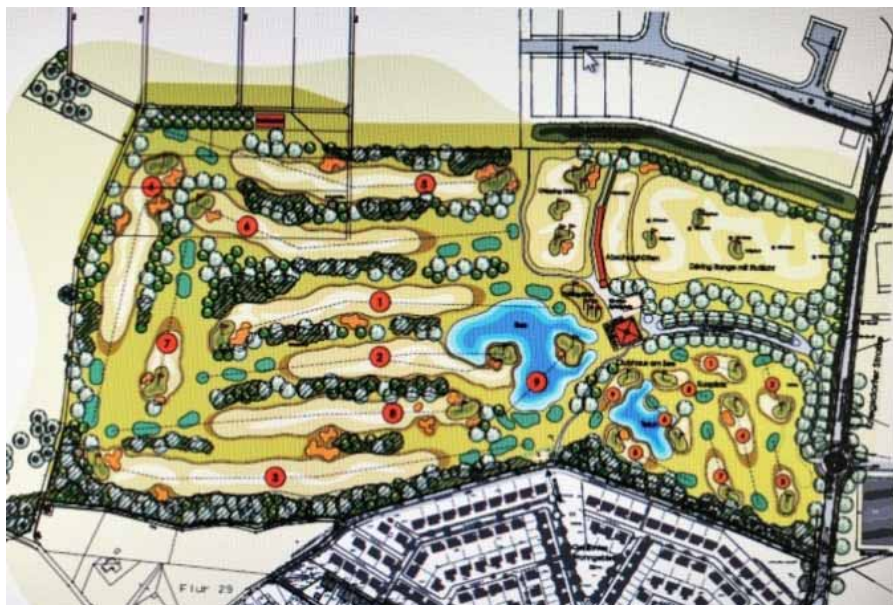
Plan der Golfsportanlage aus dem Bebauungsplan³⁰
